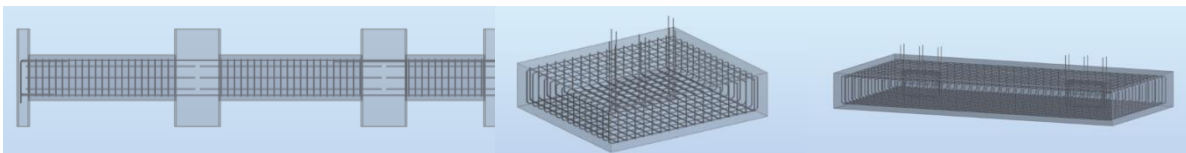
Pormenorização de armaduras em viga continua e sapatas (*Robot*).
